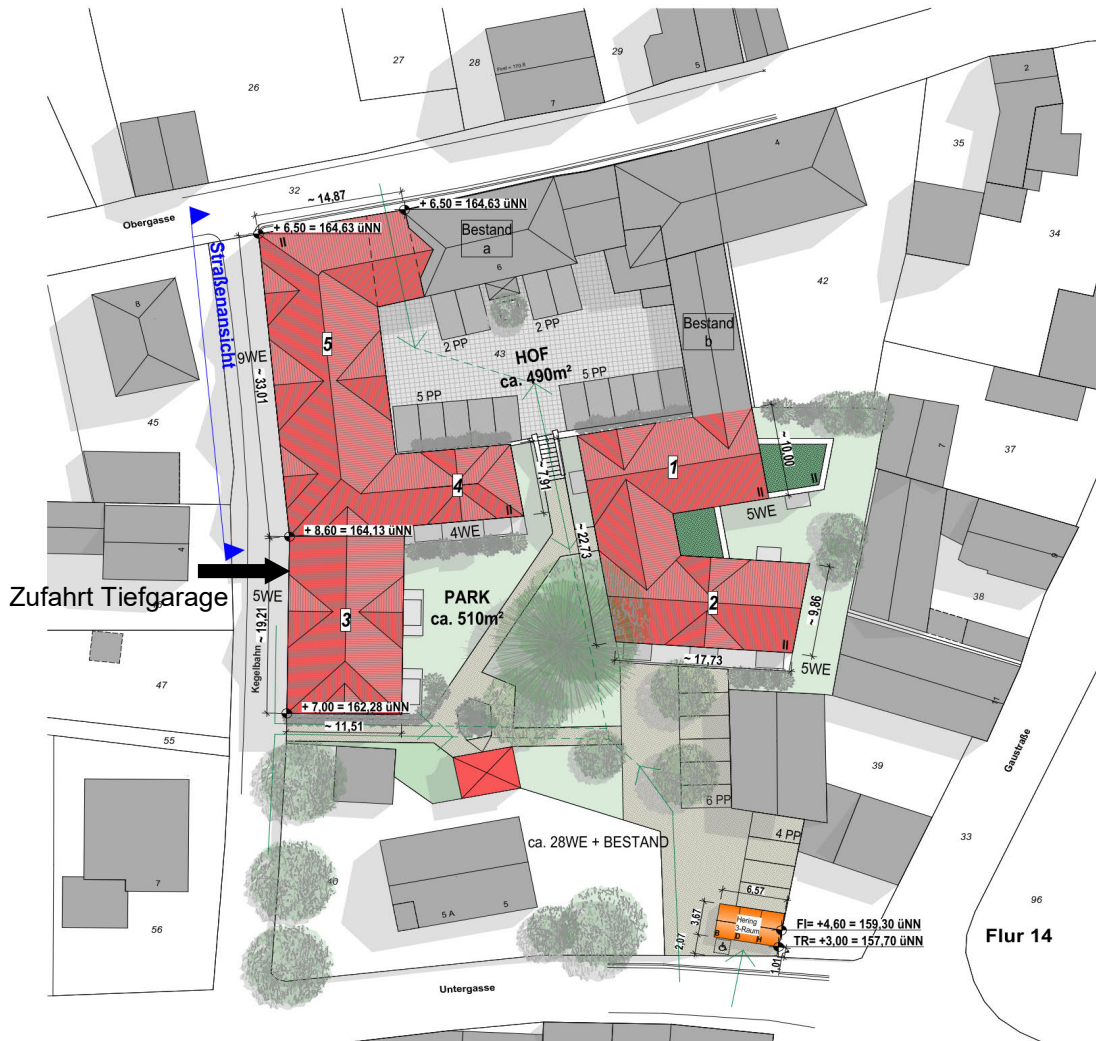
Lageplan und Baukonzept, ohne Maßstab
